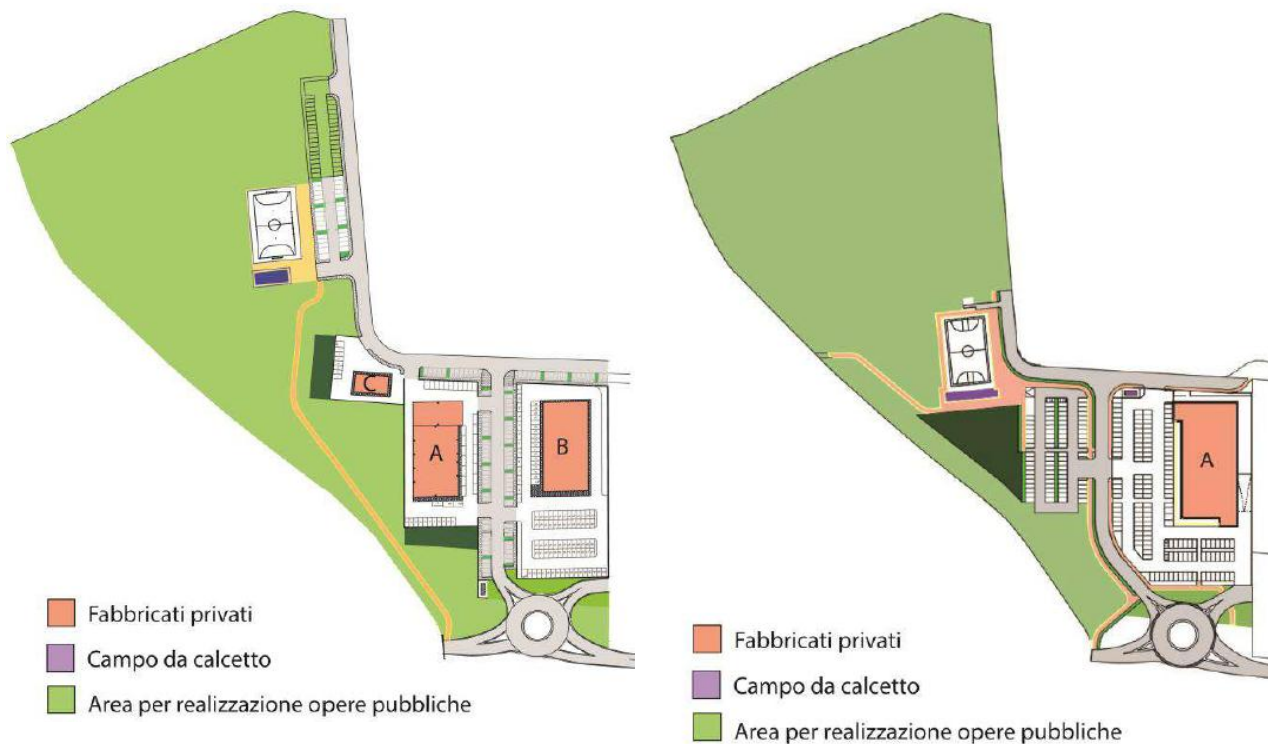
Schema di assetto urbanistico PUA “Forte Urbano - AND 29” vigente.
